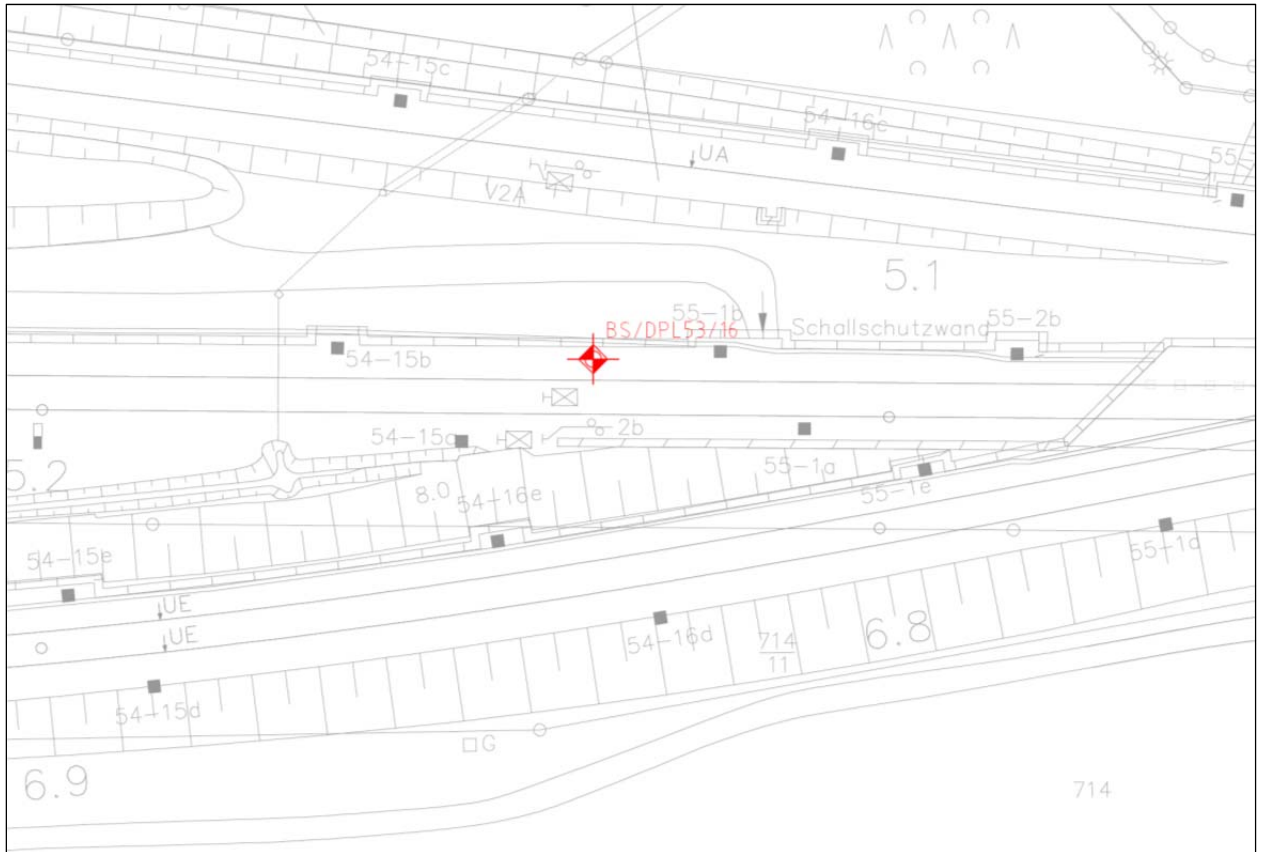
Ausschnitt aus dem IVL Plan mit Lage der BS + DPH53/16
